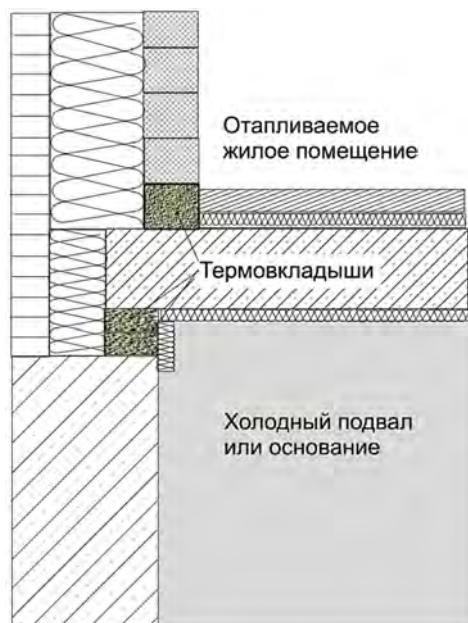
Ликвидация «теплого мостика» в месте стыка половой наружной стены с подвальным перекрытием и подвальной стеной или с плитой основания и фундаментной стеной за счет установки термовкладыша
